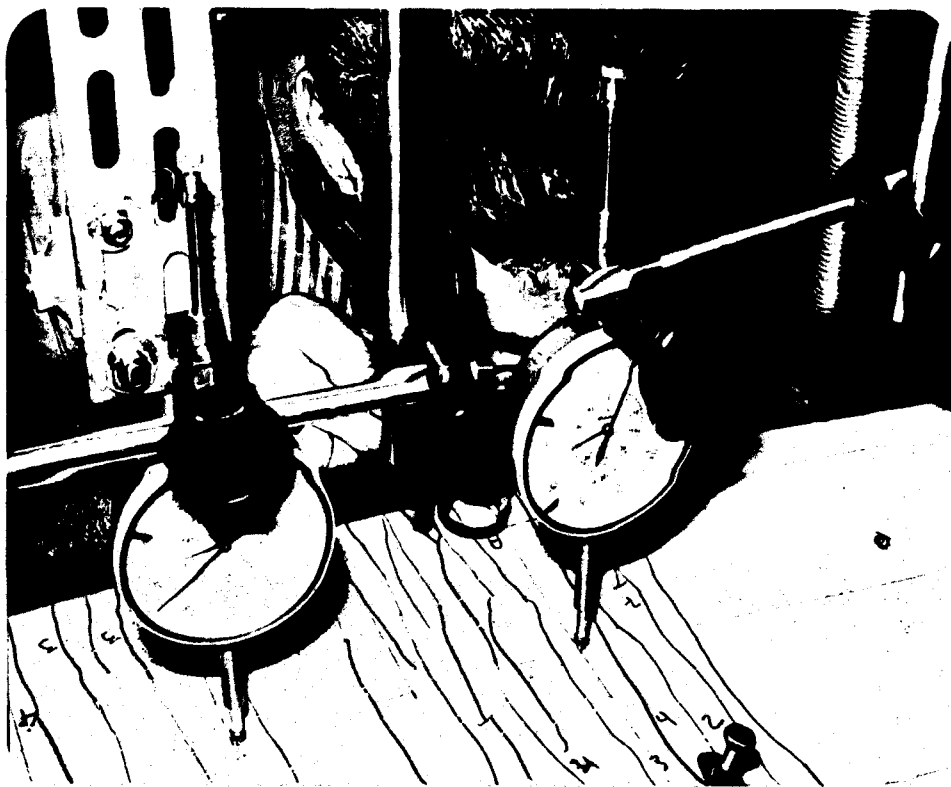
Detalhe do acompanhamento da abertura de fissuras.
